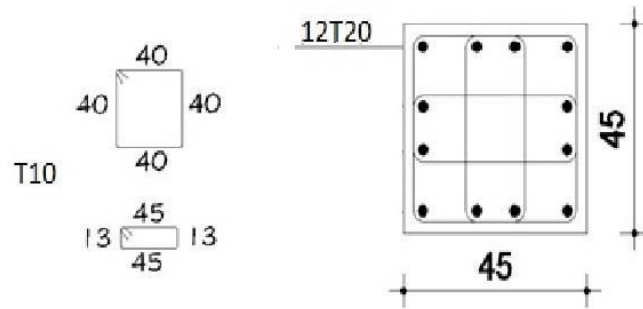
Dessin de ferrailage de poteau (45×45).
